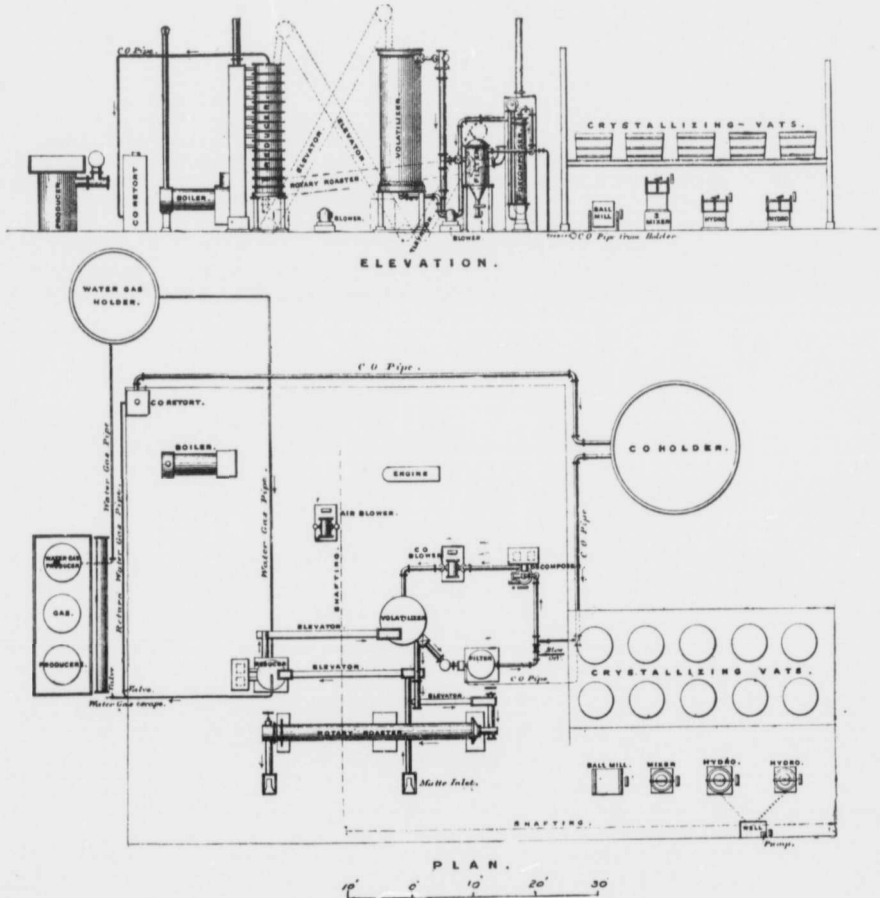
Ensemble de l'installation pour le procédé Mond; d'après Roberts-Austen
